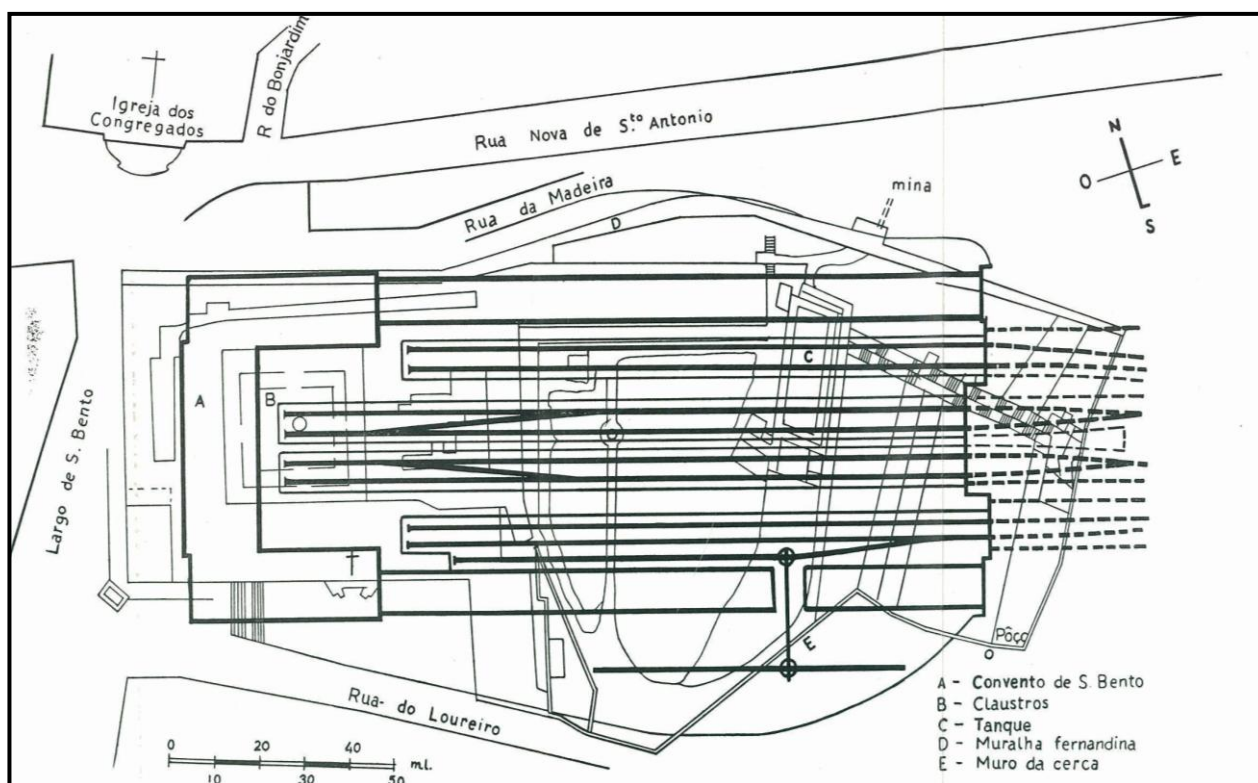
Sobreposição da planta da Estação de S. Bento sobre a planta do Mosteiro S. Bento Ave-Maria
